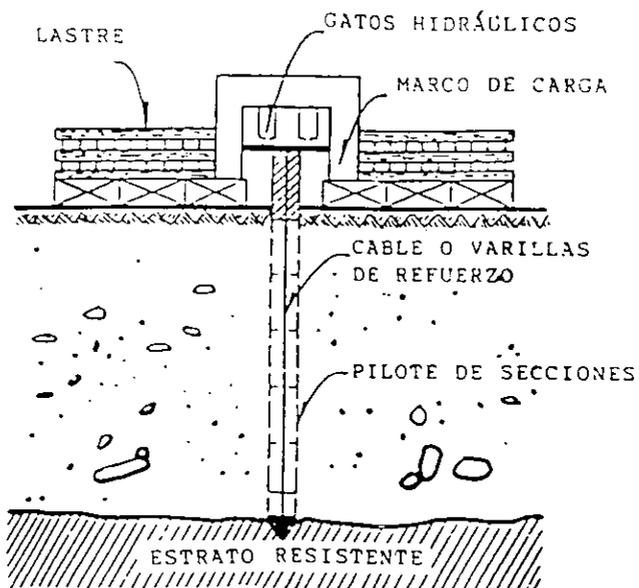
PILOTE HINCADO A PRESIÓN.
